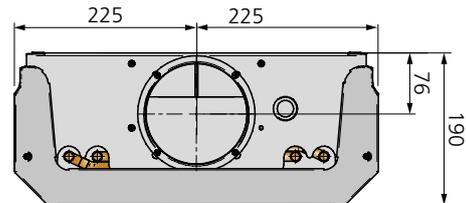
Dimensions ADRIATIC Prisma, vue arrière du raccordement aéraulique
